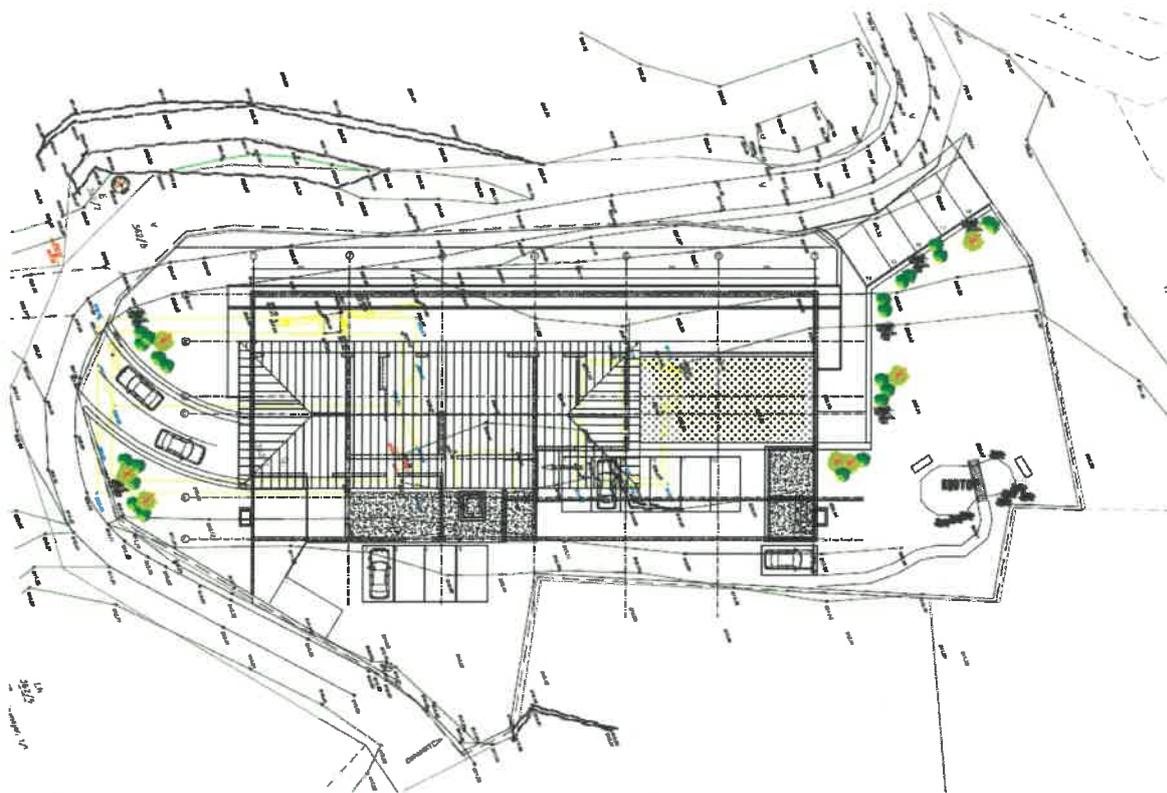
Lageplan Architektur (Quelle: Architekturbüro Lengger)
